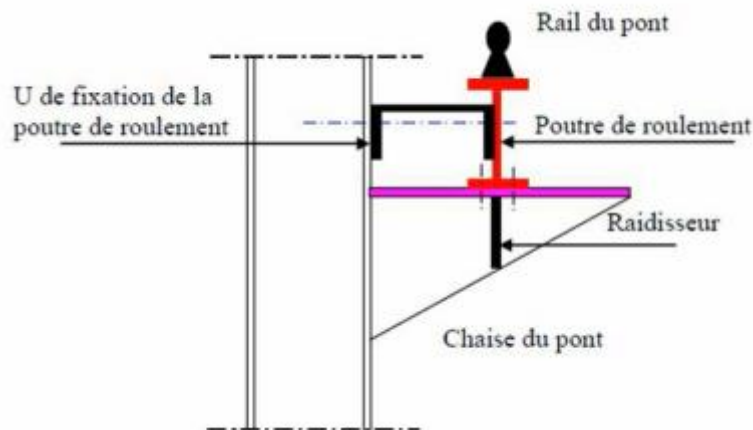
Assemblages de la chaise d'un pont roulant.
